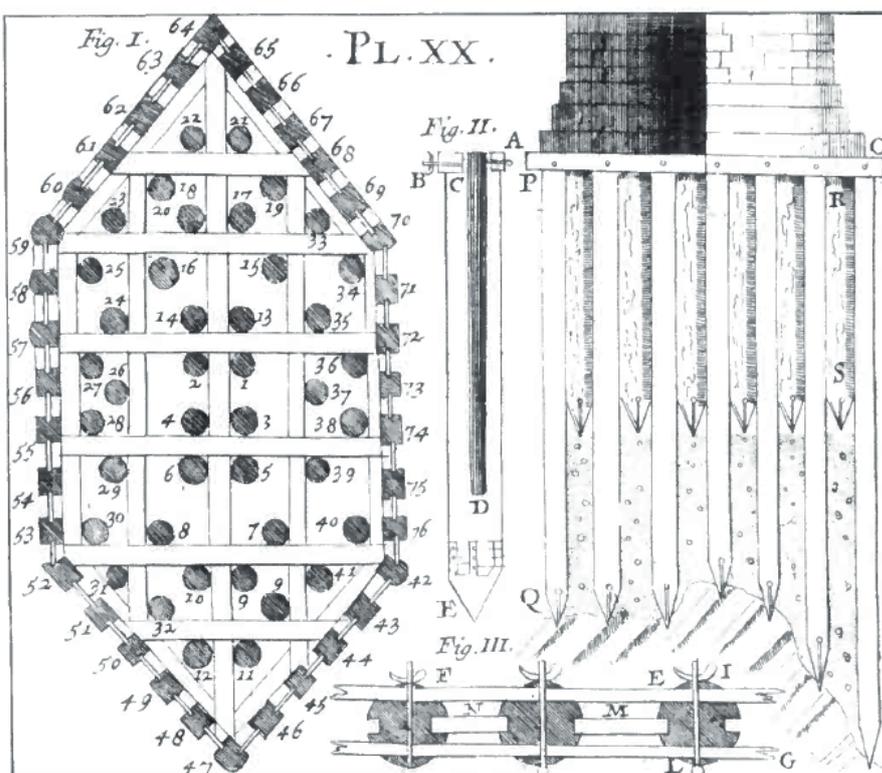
Exemple de fondation d'ouvrage en maçonnerie (extrait de [3]).
